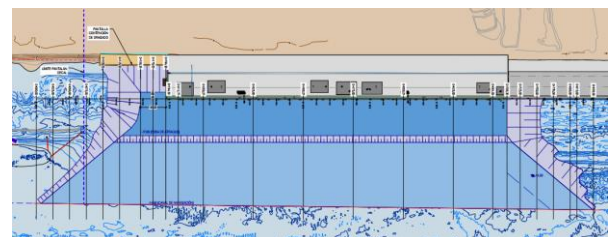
Planta de dragado Fase II. Cota -17.0 m.
